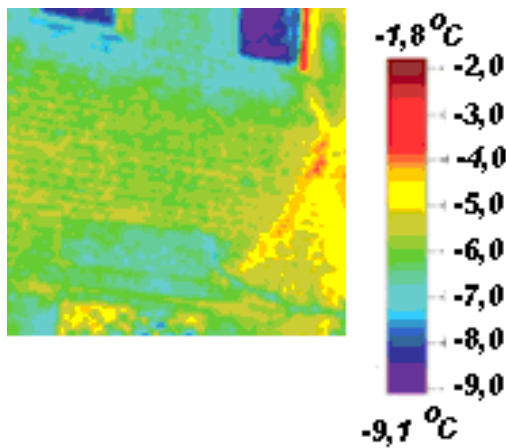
Термограма фрагменту стіни будівлі з тріщиною / Thermogram detail of the building wall with a crack
